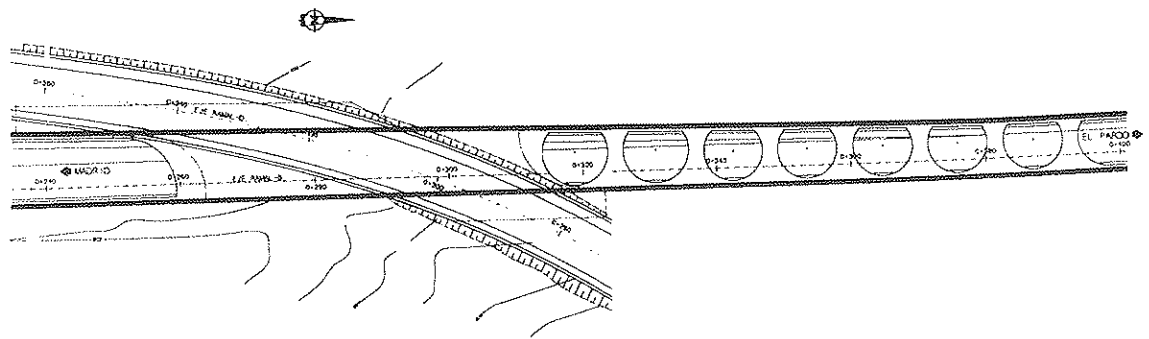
Paso inferior de la Carretera de El Pardo. Planta.
